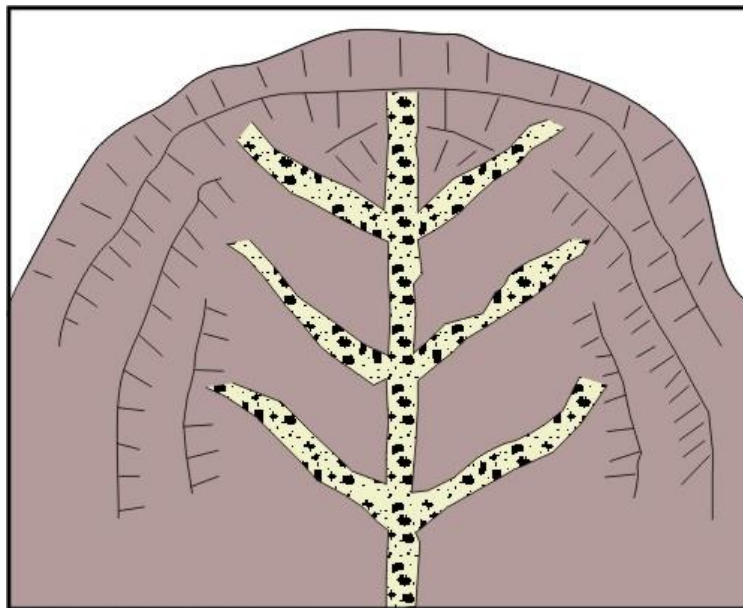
Sistema de drenaje tipo espina de pez (INGEMMET 2003)
